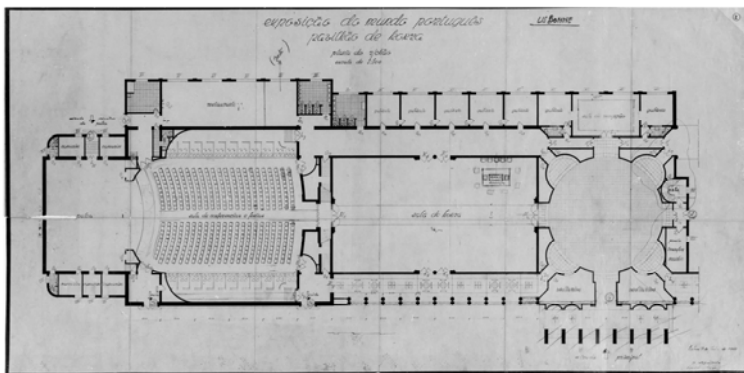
| PAVILHÃO DA HONRA [PLANTA, 10 DE JUNHO DE 1939]
